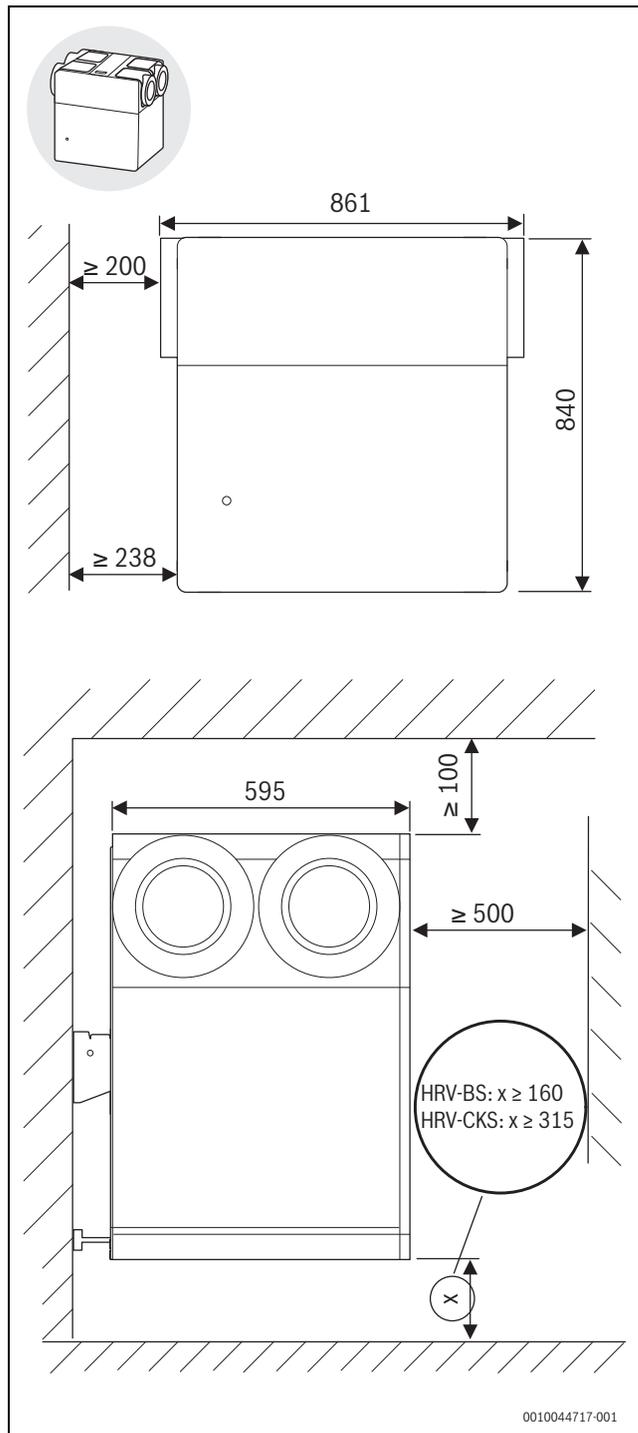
Abmessungen und Mindestabstände Wandinstallation HRV176... - Mindestabstände wenn Anschlussstutzen waagrecht
